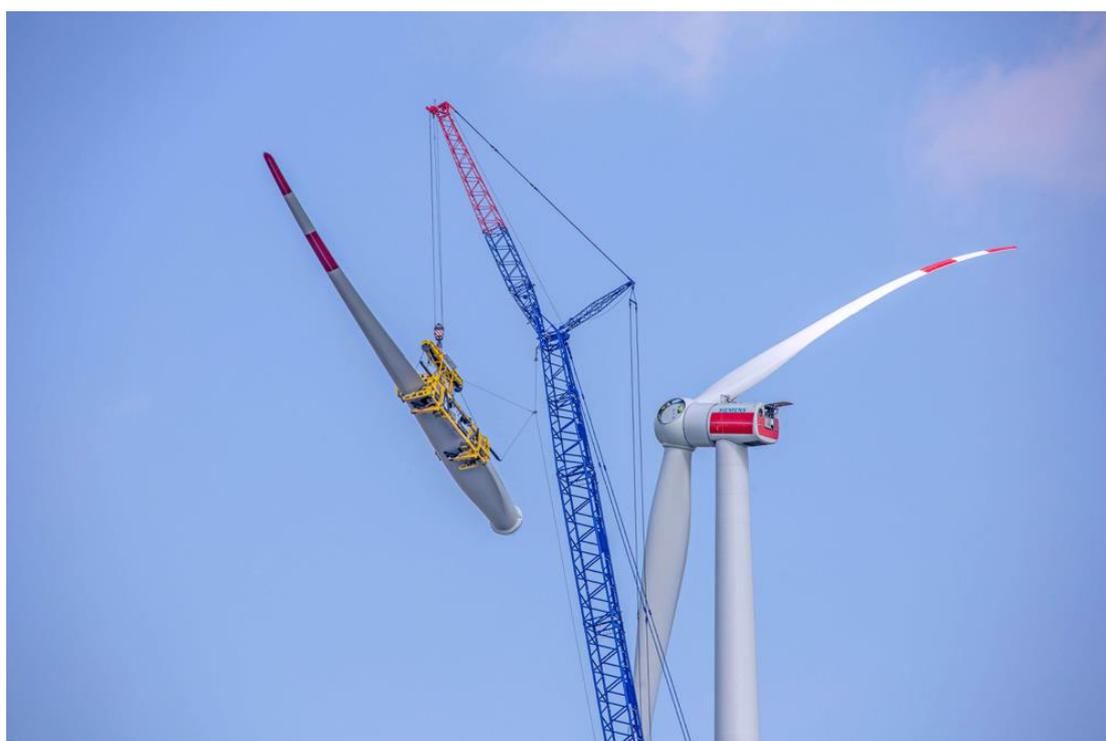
Montaggio pale attraverso la gru Liebherr LR 1600 2W
